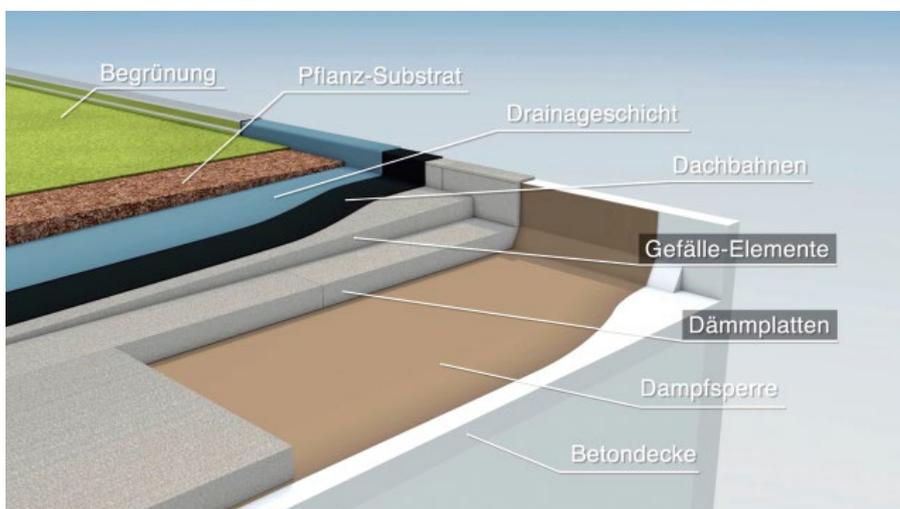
Einschaliges Flachdach – schematischer Aufbau auf einer Betondecke
